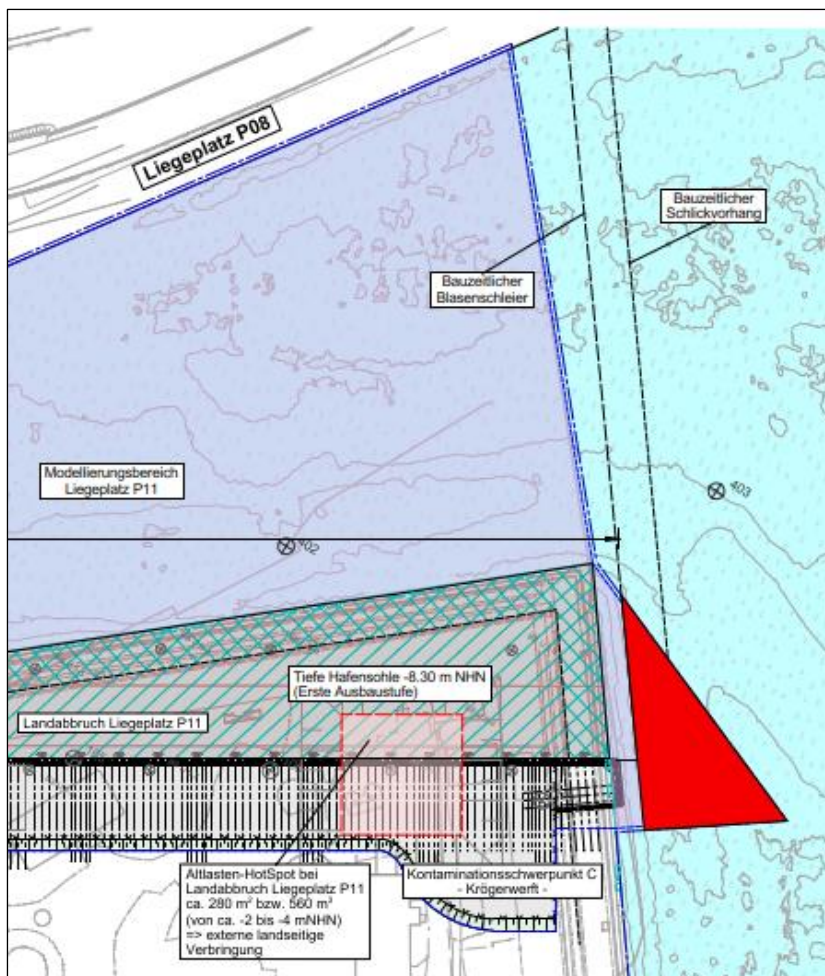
Lageplanausschnitt Nassbaggerungen (Bereich außerhalb Hafenbecken - rot)
